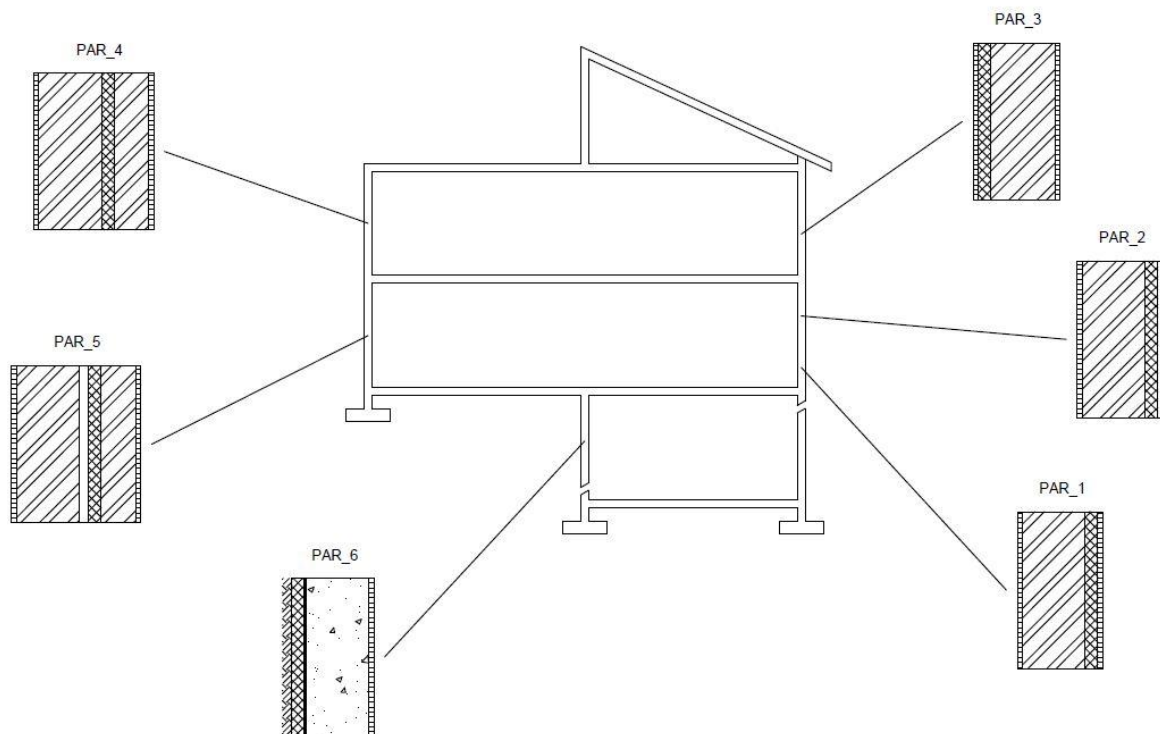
Soluções correntes de paredes em edifícios com estrutura porticada de betão armado
